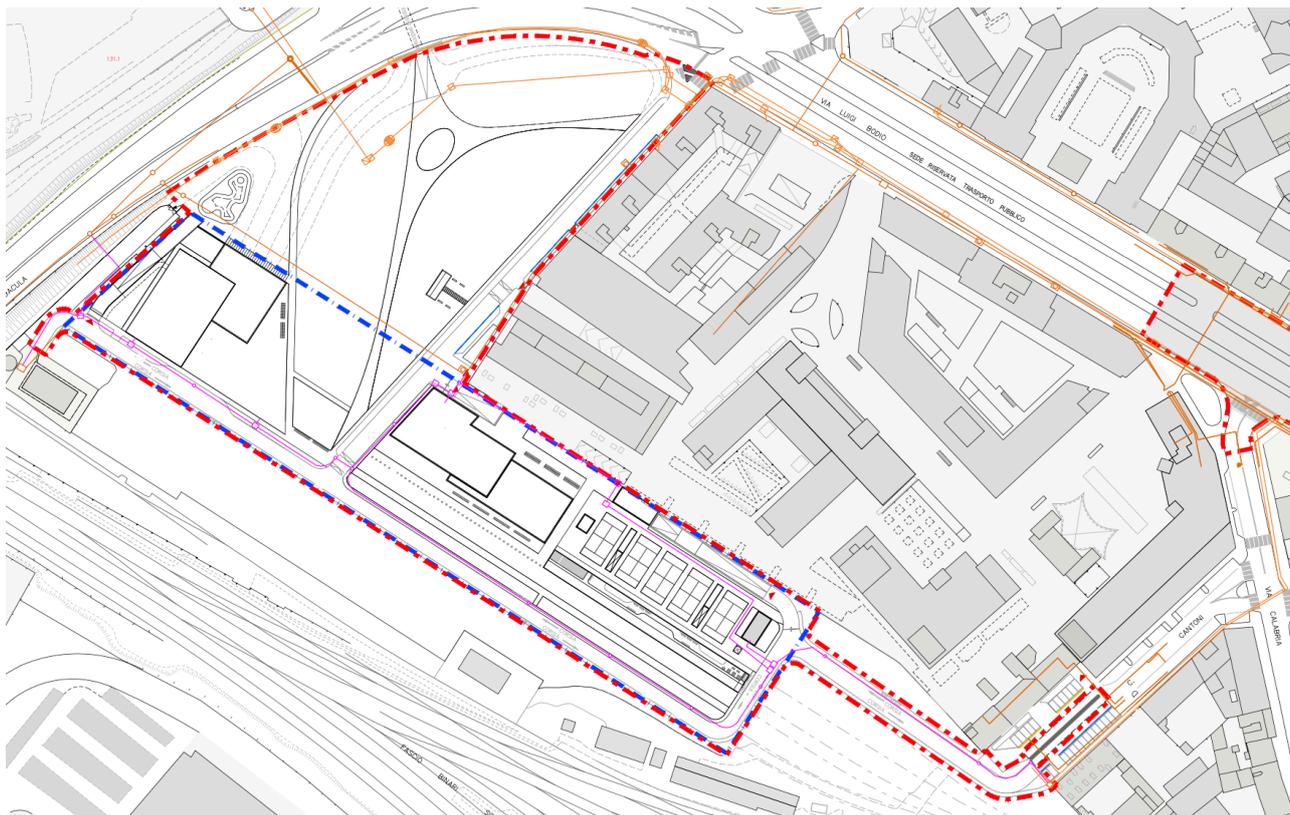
Rete telefonica– Planimetria (rif tav. 21IRM015-PP-SER-DR-E.04)
